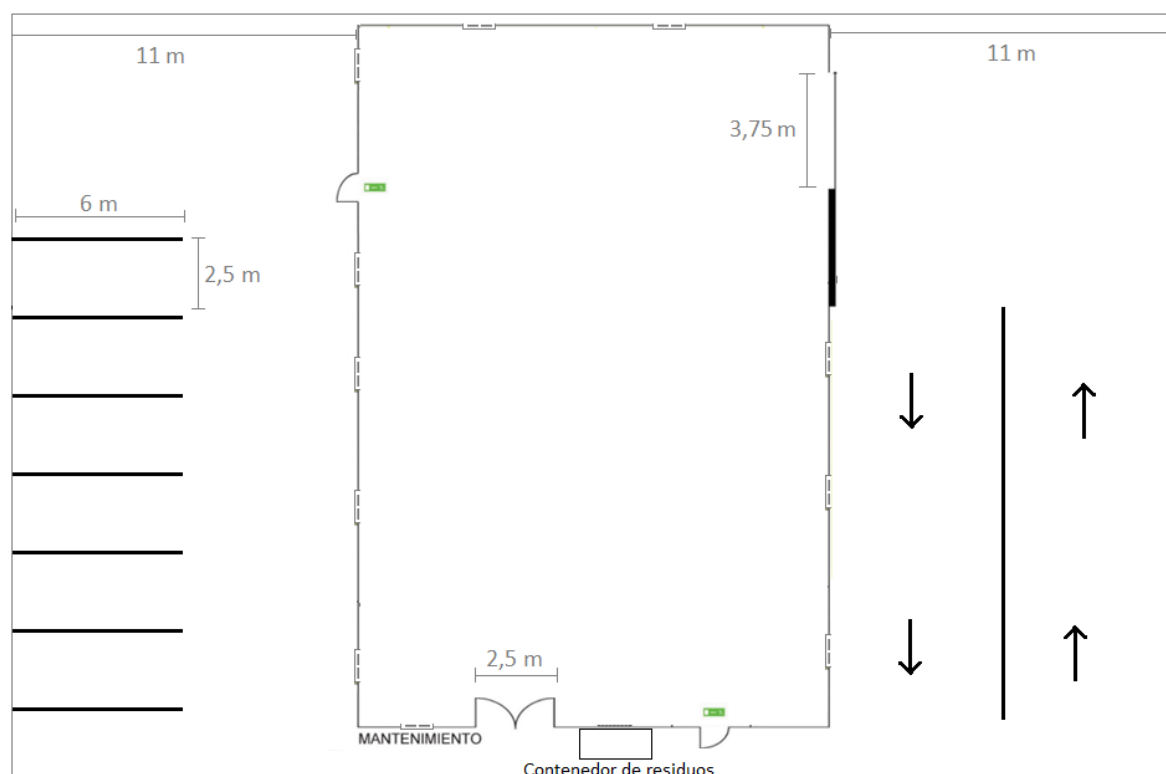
Plano del exterior de la planta Fuente: Elaboración Propia
